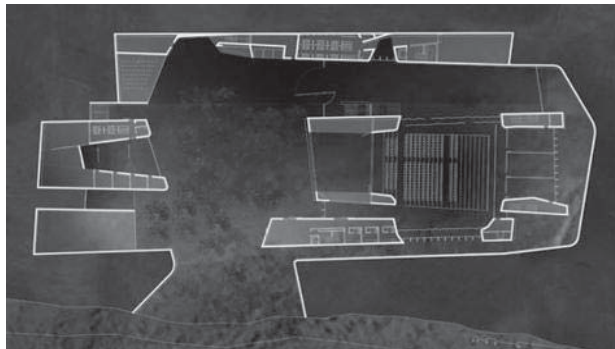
Planta arquitectónica del auditorio Morro Jable. Autor [ArquiNETWORK]
